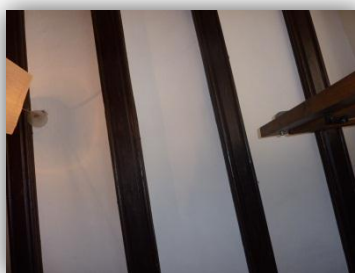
Forjado de planta baja de la vivienda 3. Fuente Propia
